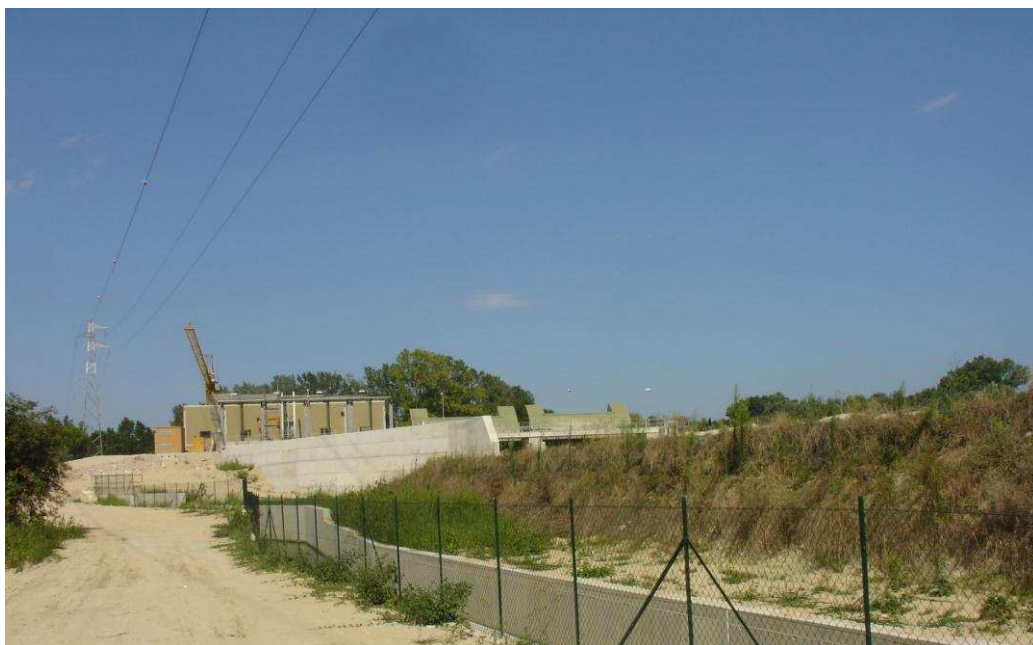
Modifica planimetrica del tratto terminale del fosso Madonna. Tratto interessato dagli interventi.
